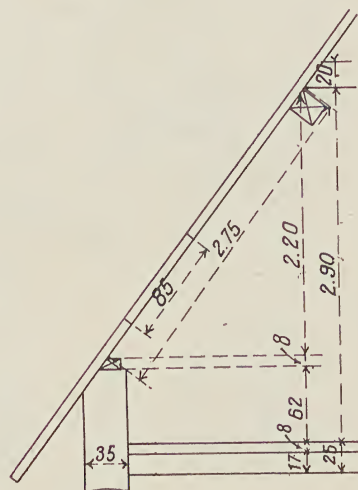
Façade latérale de gauche coupe sur GH (*fig.* 730).
